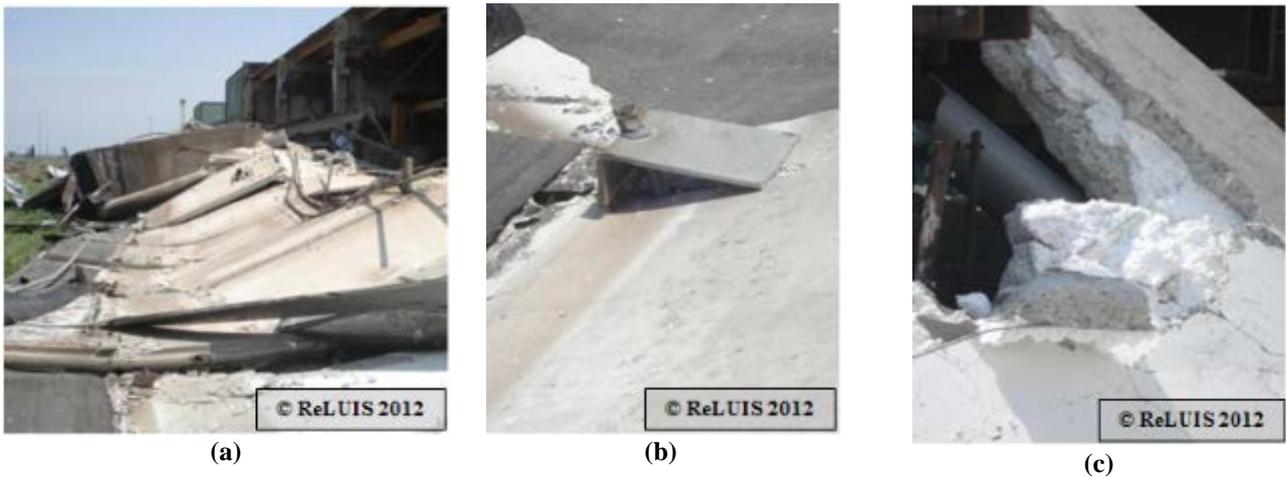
(a) Crollo dei pannelli verticali di tamponamento: (b) dettagli profili della quadretta e del bullone ancora inserito nel profilo a C del pannello crollato e (c) dettaglio sezione trasversale del pannello verticale, costituito da calcestruzzo armato e materiale di alleggerimento e isolante
